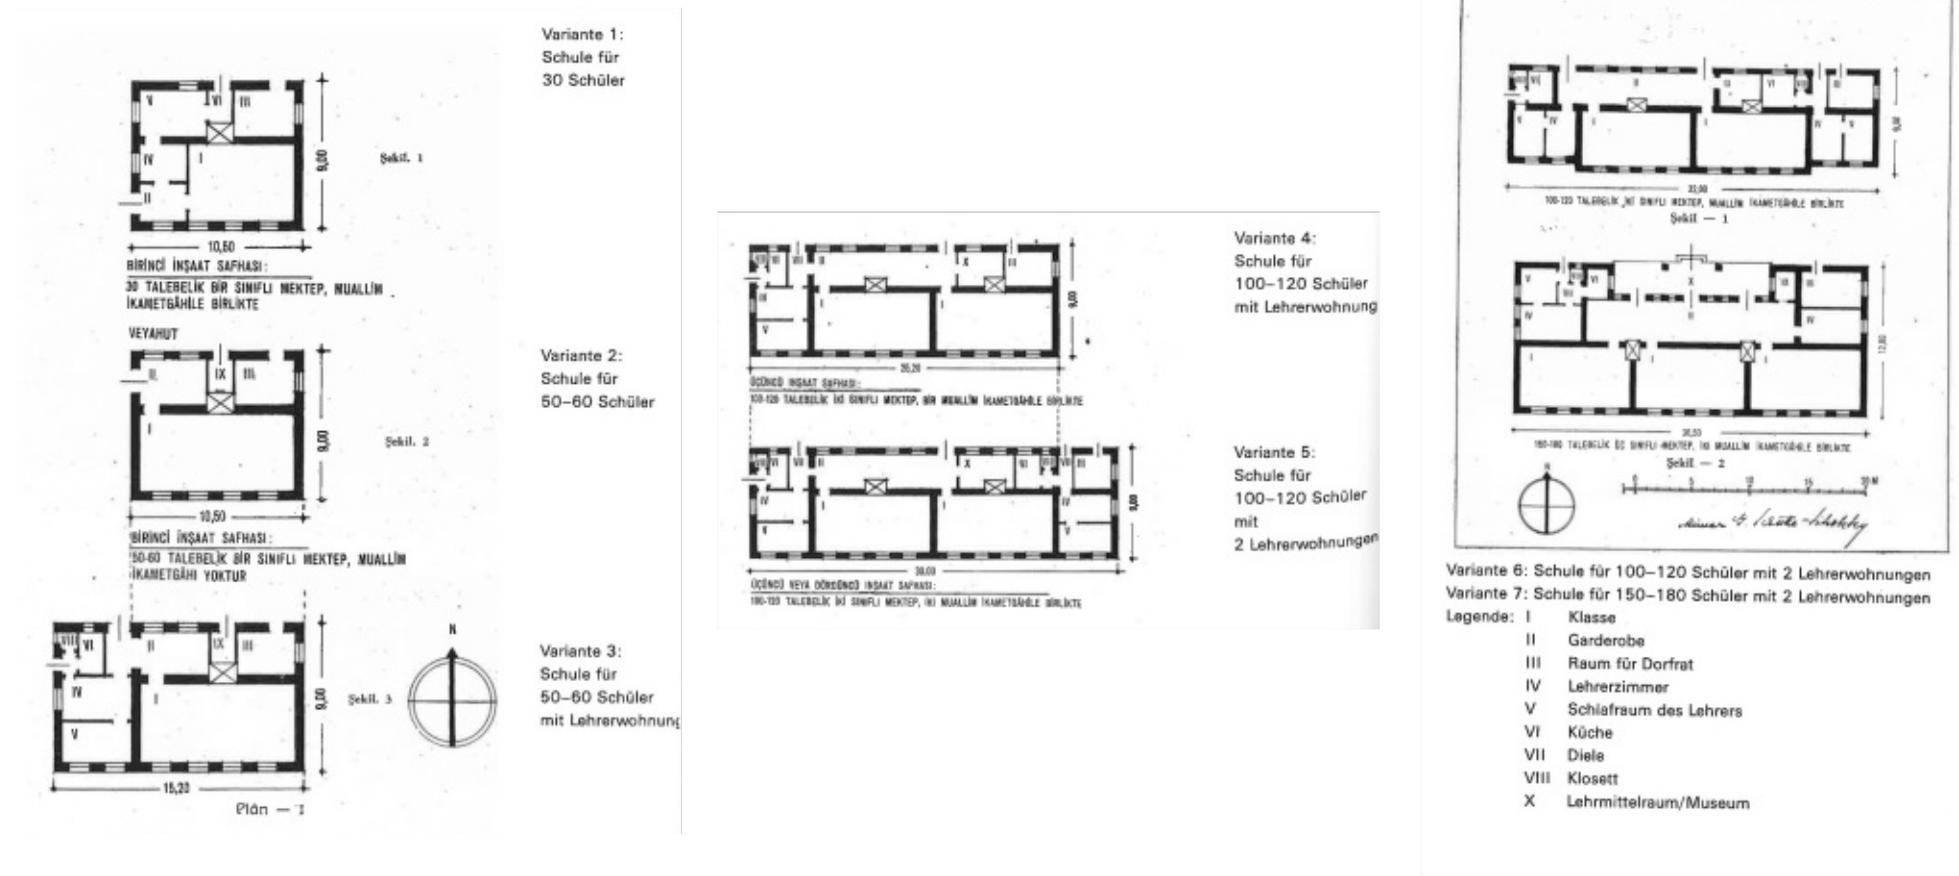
Grundrisse der Prototyp-Projekten für Dorfschulen in der Türkei, Margarete Schütte-Lihotzky unter Konstruktionsbüro
